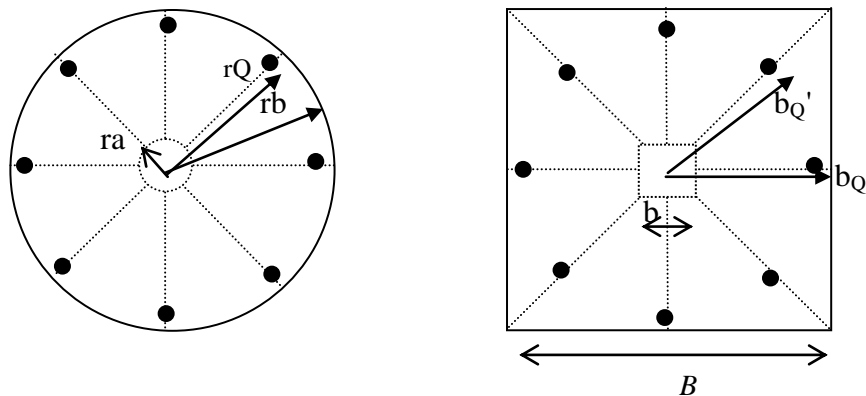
dalles d'essais circulaire ou carrée en laboratoire avec les points d'application des charges ponctuelles
